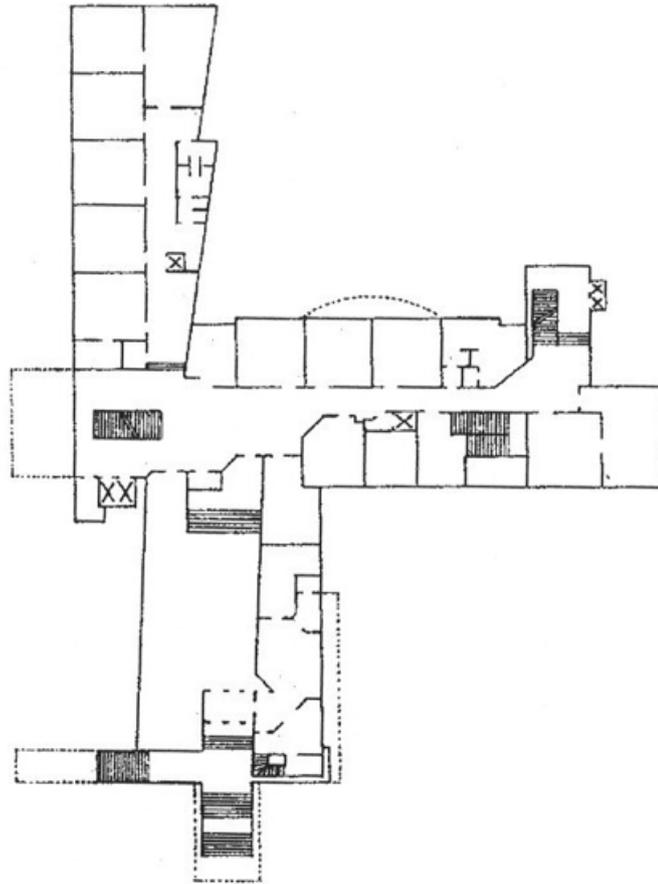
Lageplan mit der Aufteilung, M 1:1000
